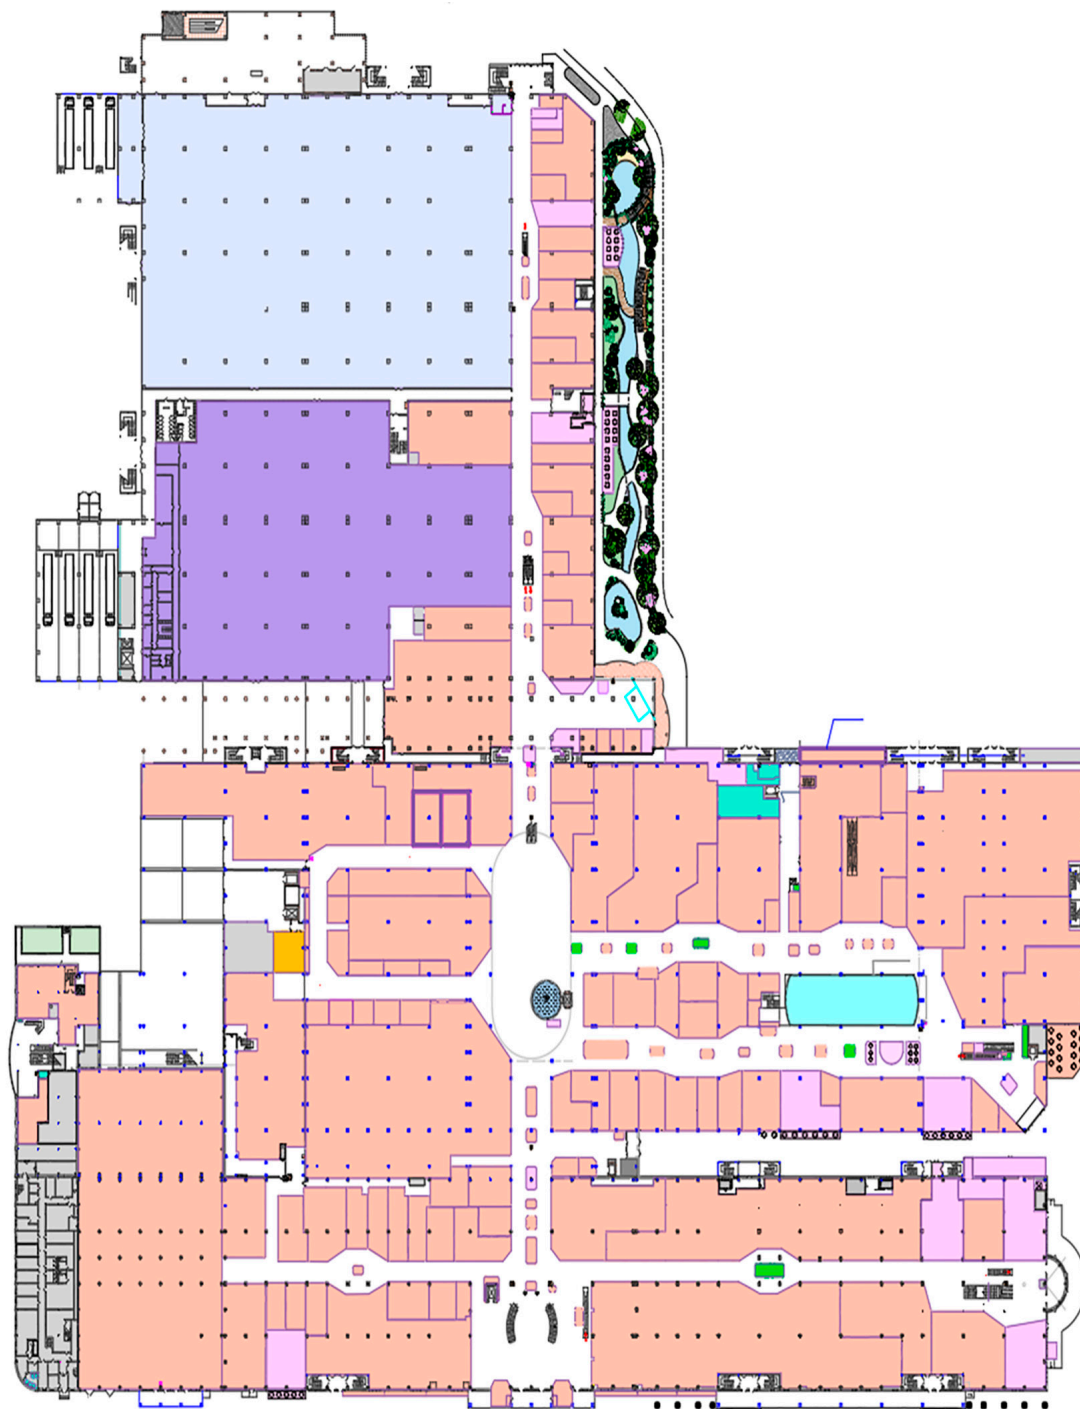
План 1-го этажа ТРЦ «Красная площадь»
